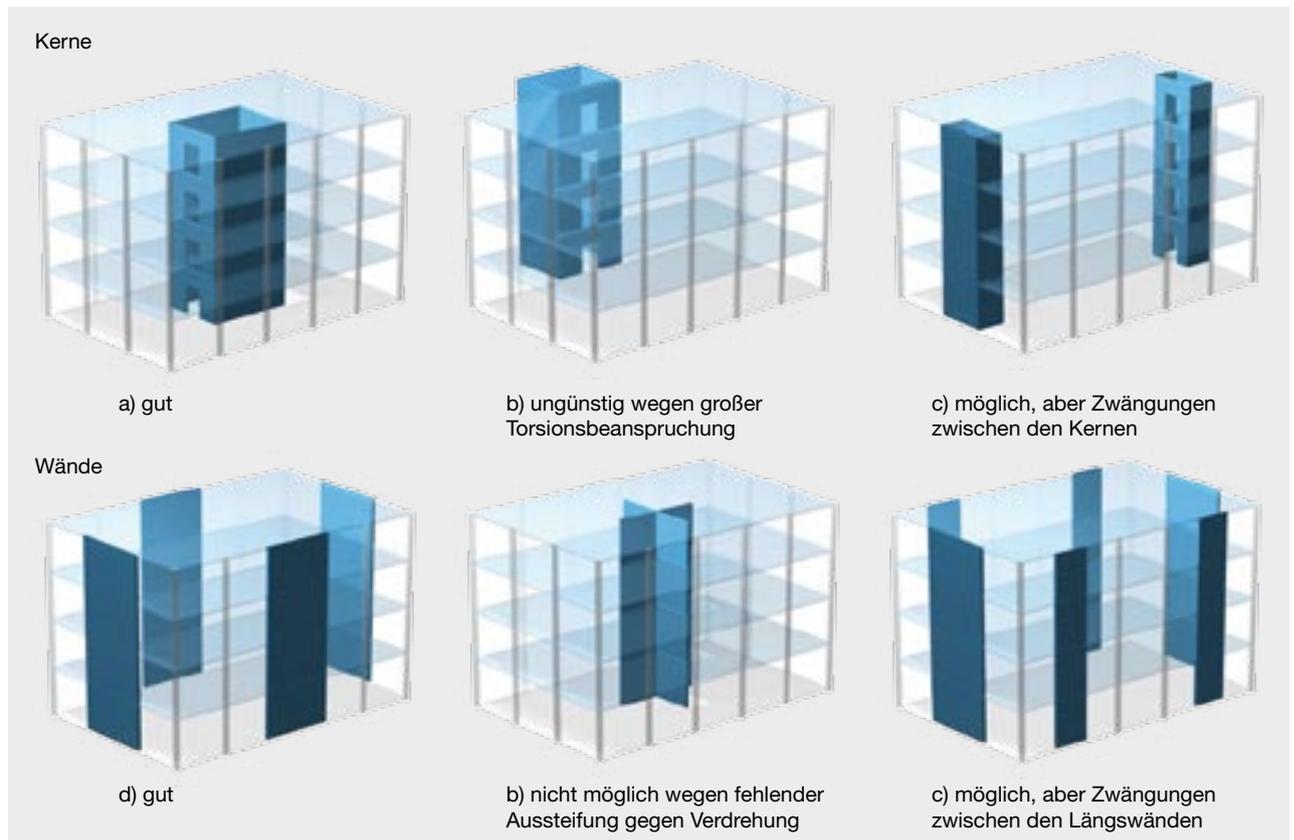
Anordnung vertikal aussteifender Bauteile
